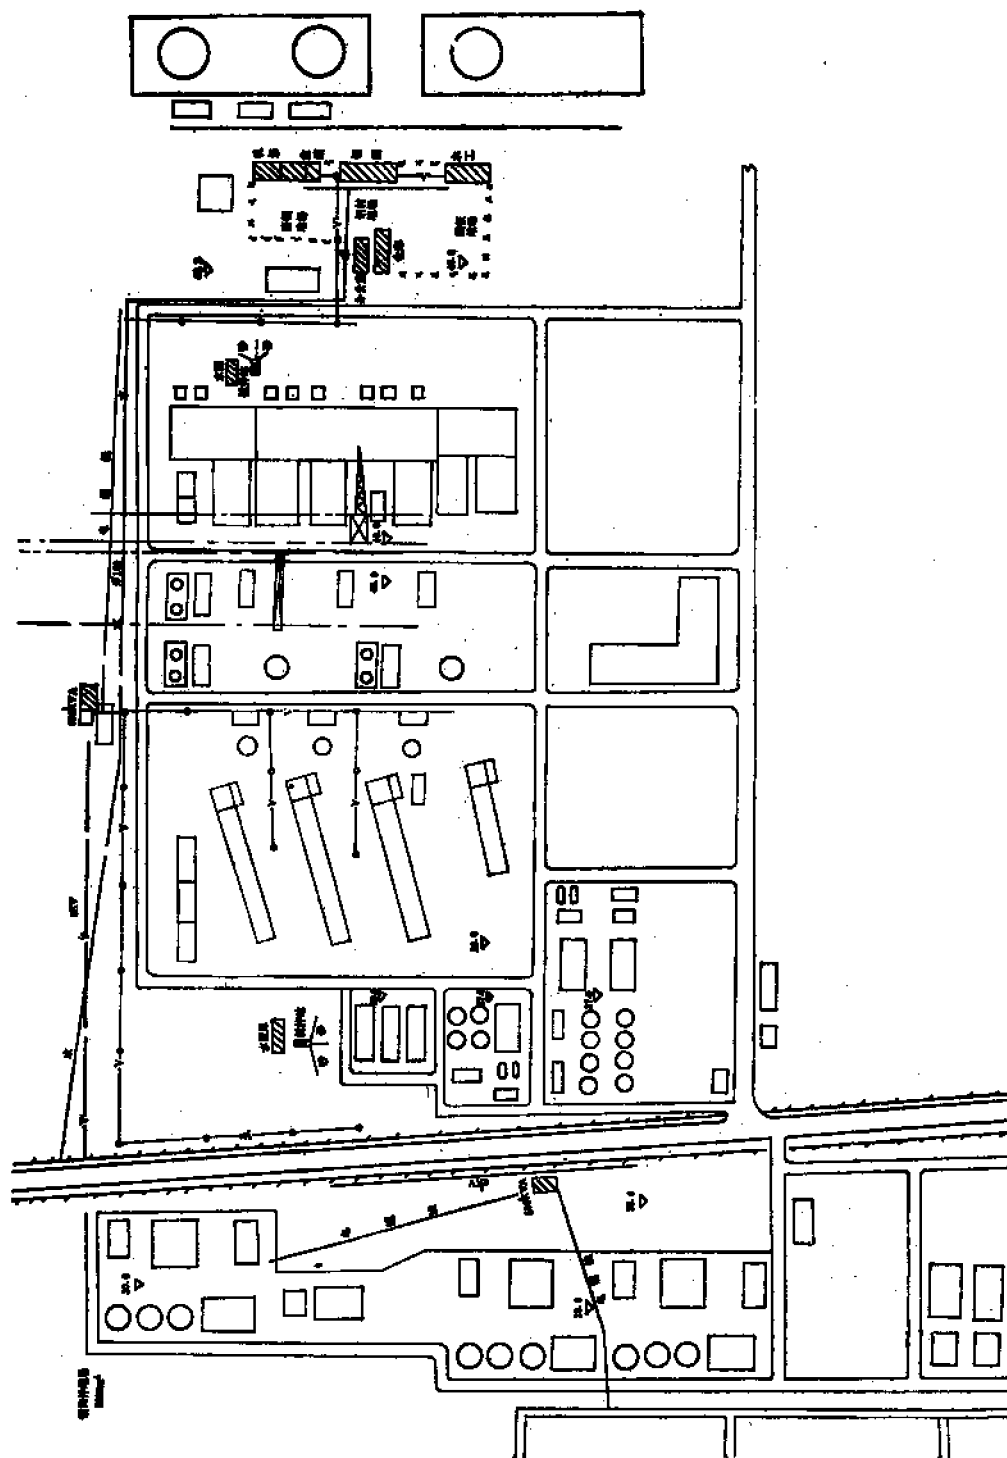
(8) 贾姆肖罗电厂施工总平面布置图
